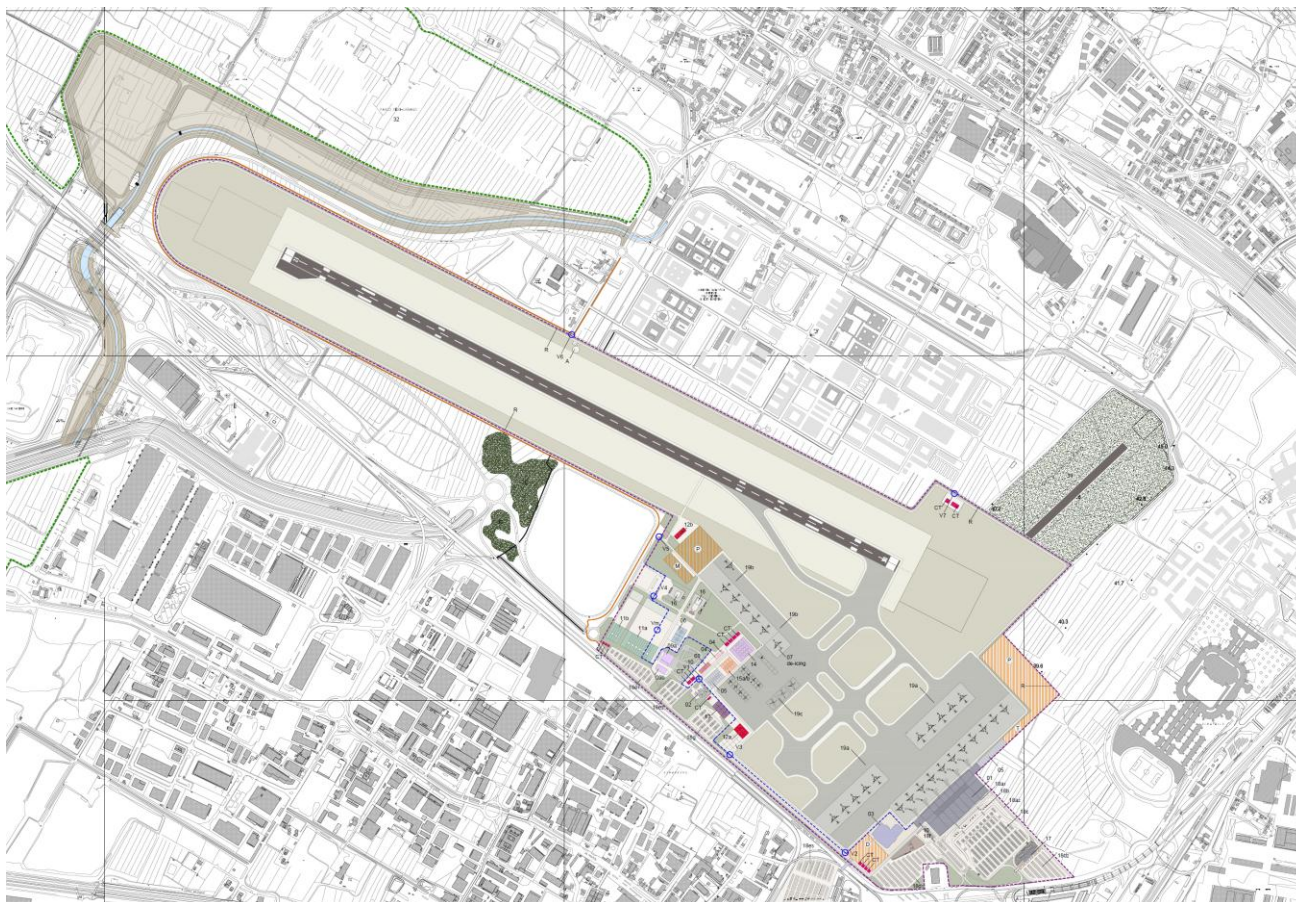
Configurazione planimetrica della nuova pista (Master Plan, scenario 2029)
